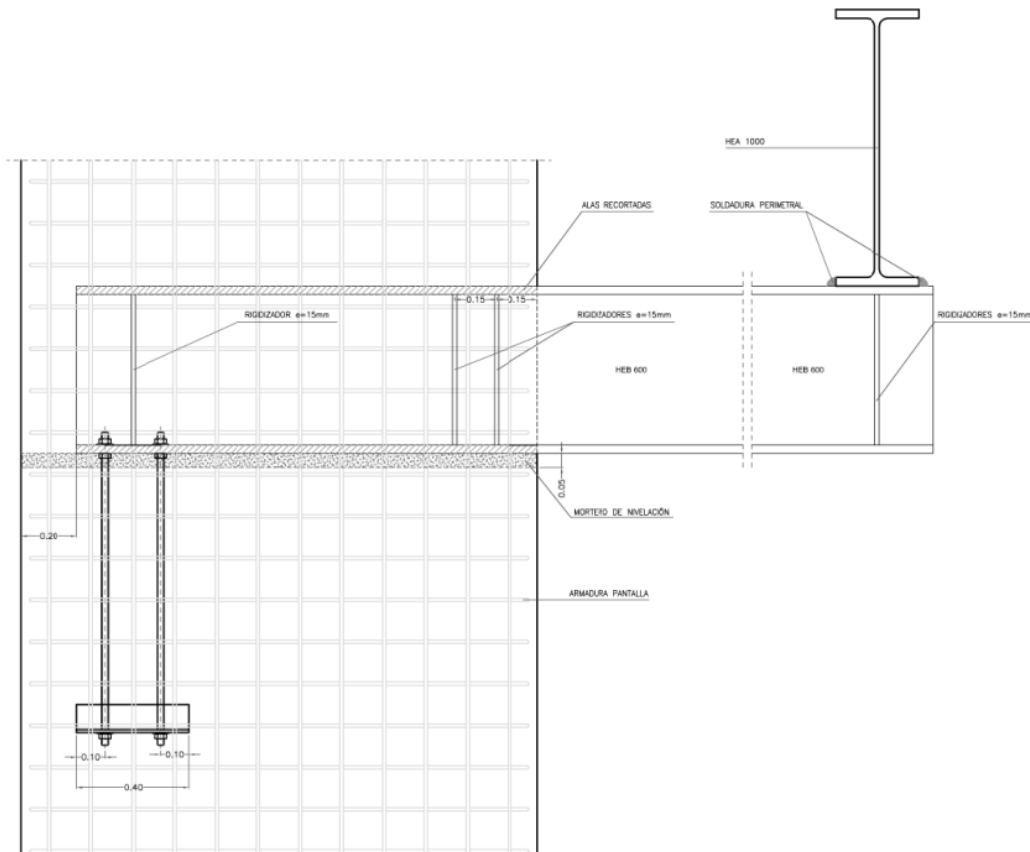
Sección transversal tipo de la estructura de apeo de viga principal HEA1000
